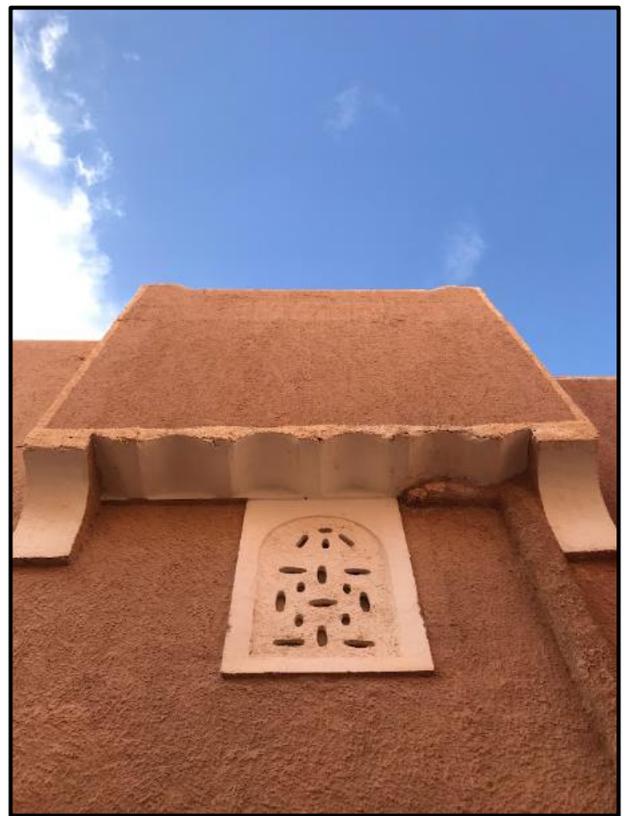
Photo de revêtement de mortier de chaux avec le régime de dattes sur la façade de la maison de Tafilalt
